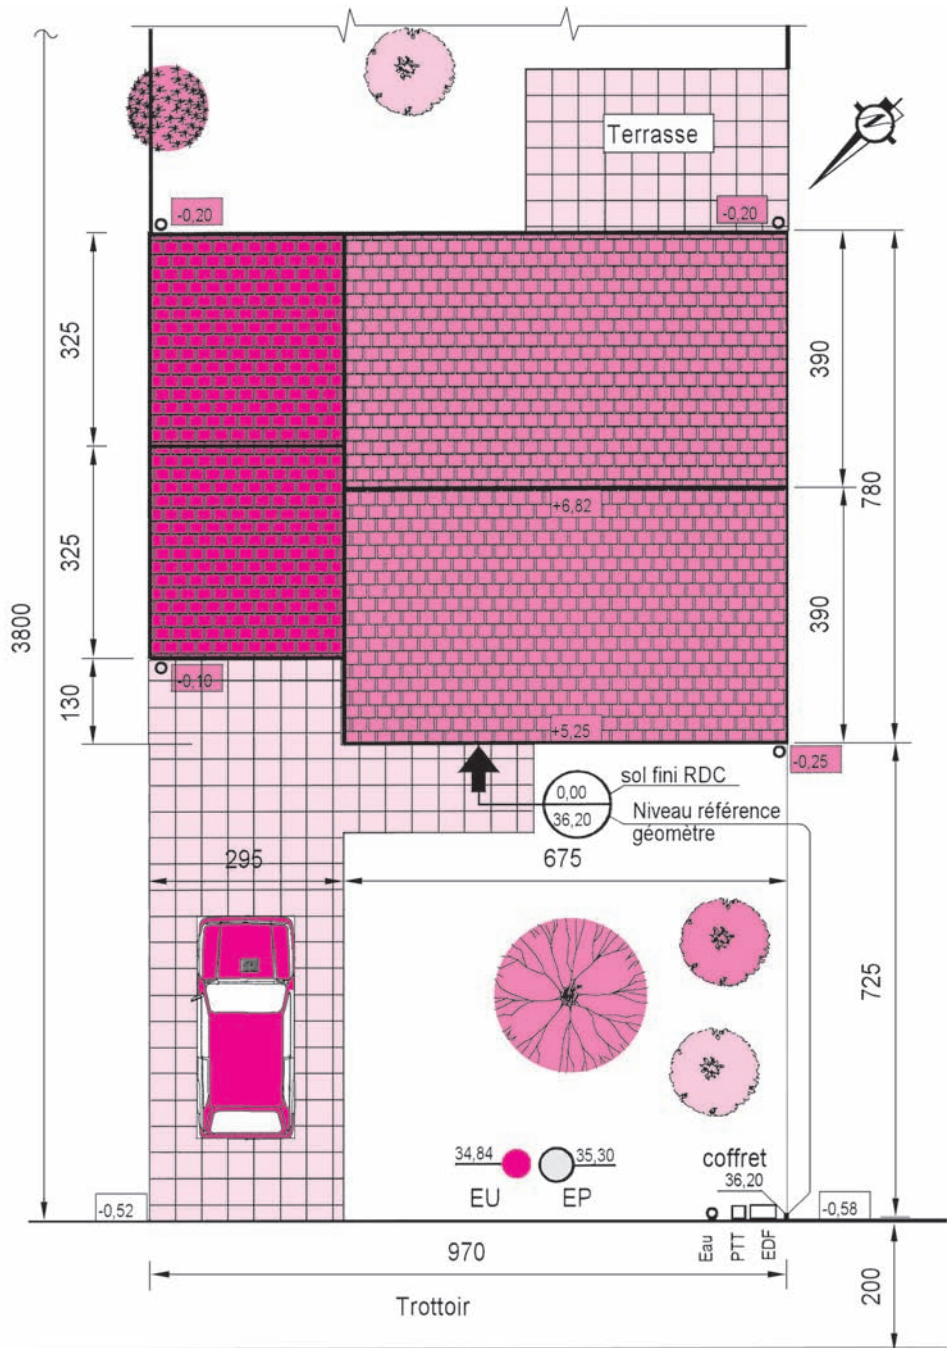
Plan de masse avec position des boîtes de branchement EU et EP et les altitudes
